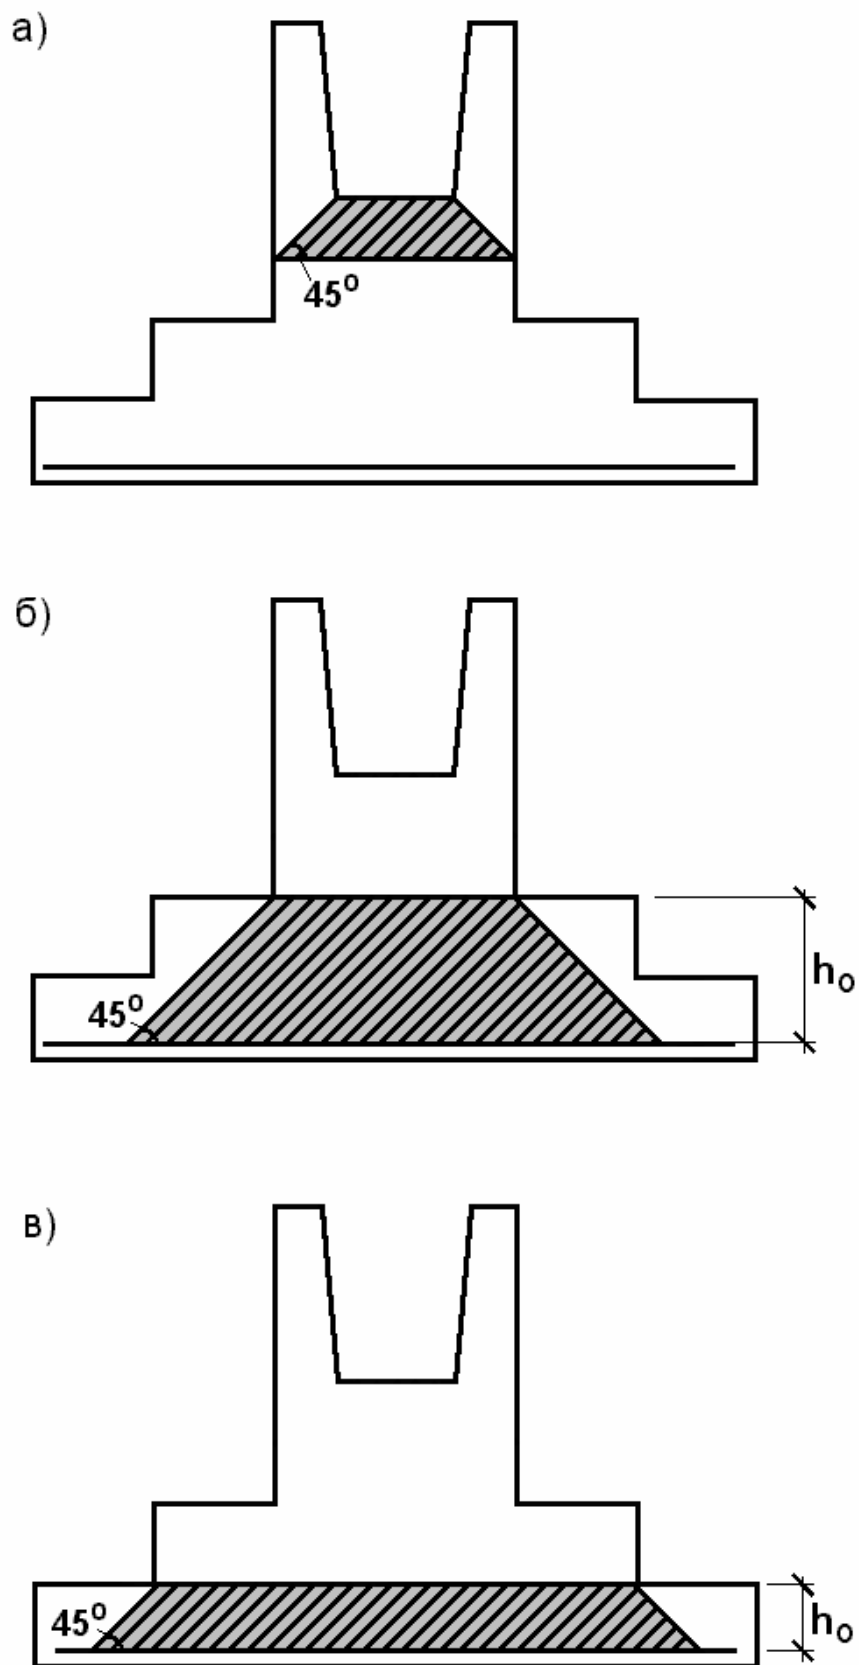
Схема пирамиды продавливания: а – продавливание колонной дна стакана (пирамида продавливания вышла за пределы фундамента); б, в – продавливание различных ступеней плитной части фундамента.
